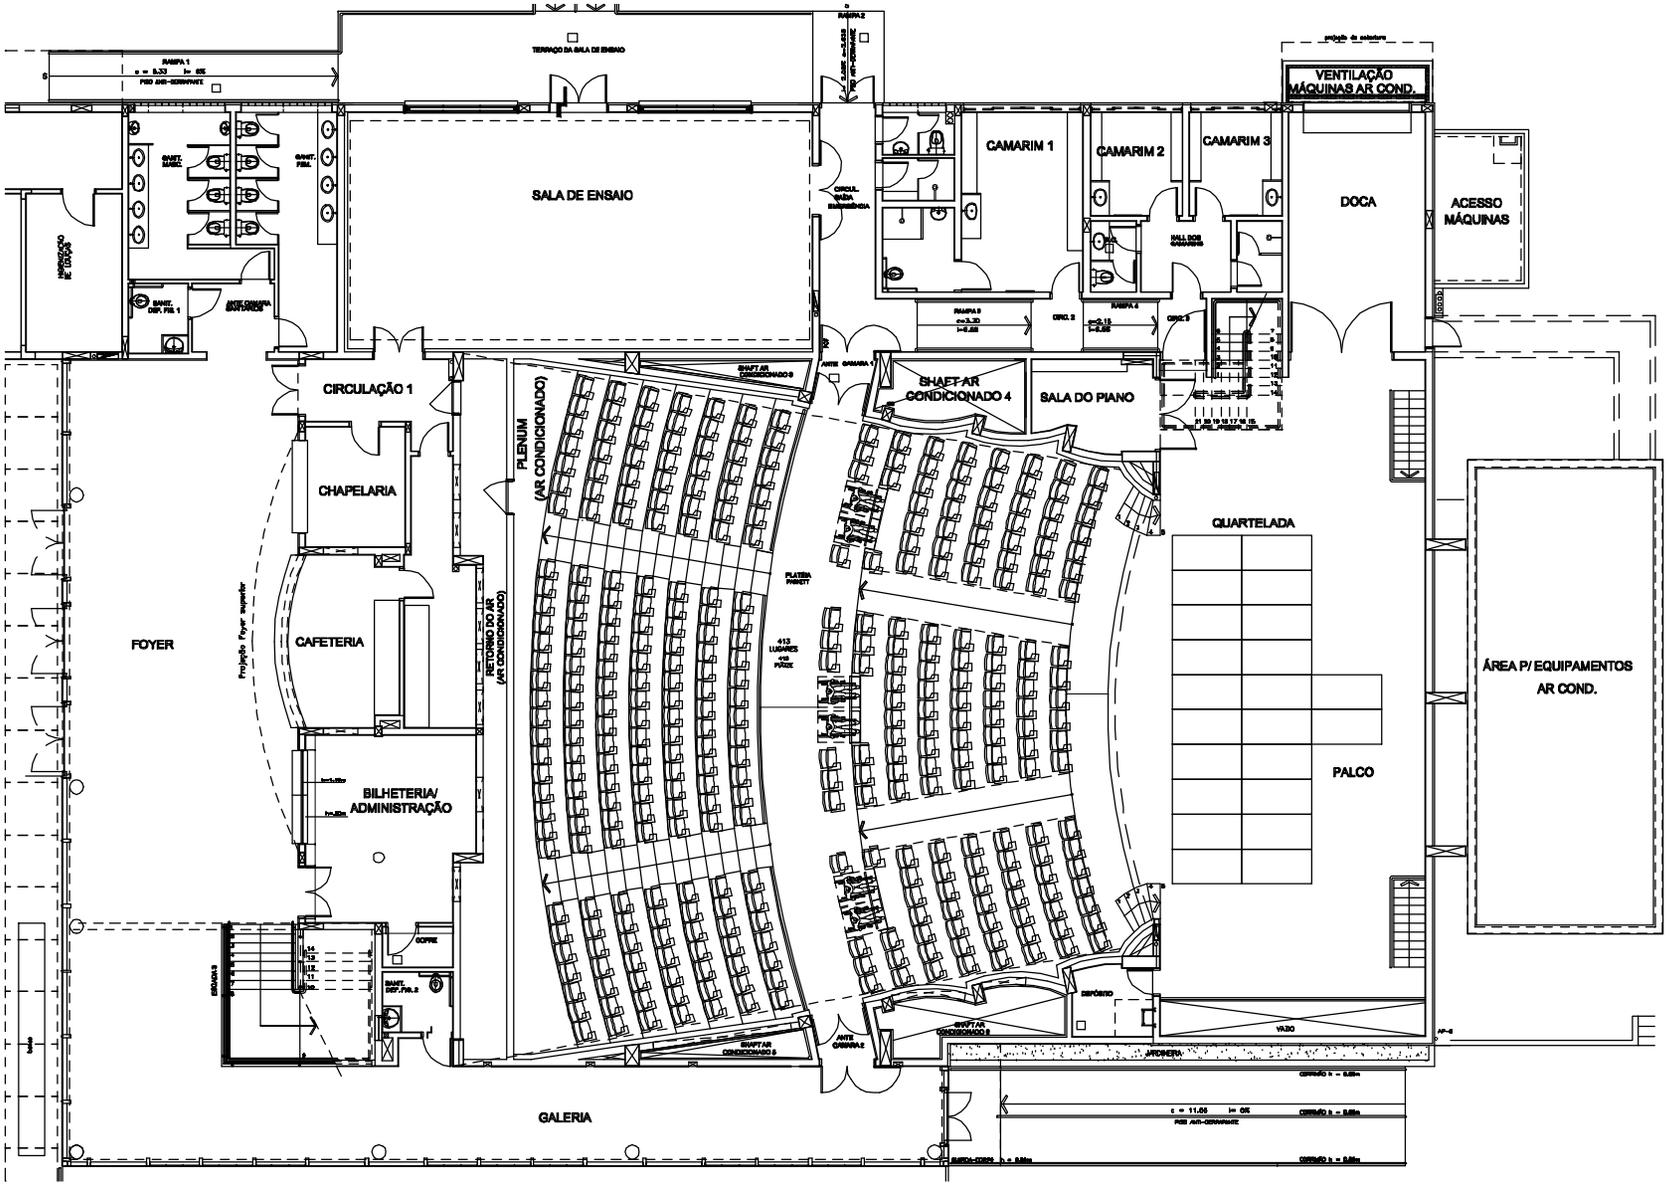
Planta do Pavimento Térreo – Auditório do Colégio Humboldt – Esc. 1/200
